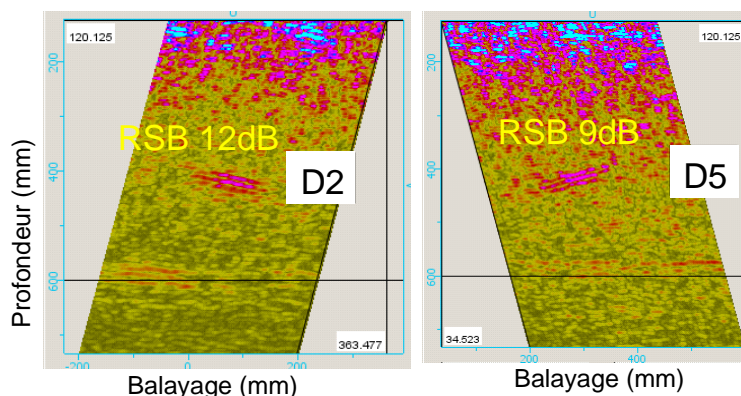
Détection de défauts plans orientés dans la maquette ferrillée, pour D2 et D5 loi L15P400mm
